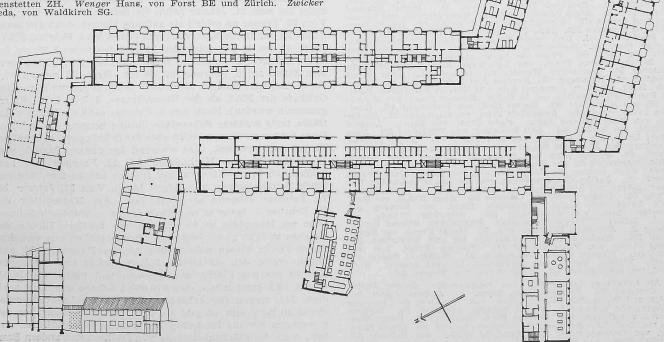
Hoje Soborg, Erdgeschossgrundriss, Normalgeschossgrundriss und Schnitt, 1:1200
